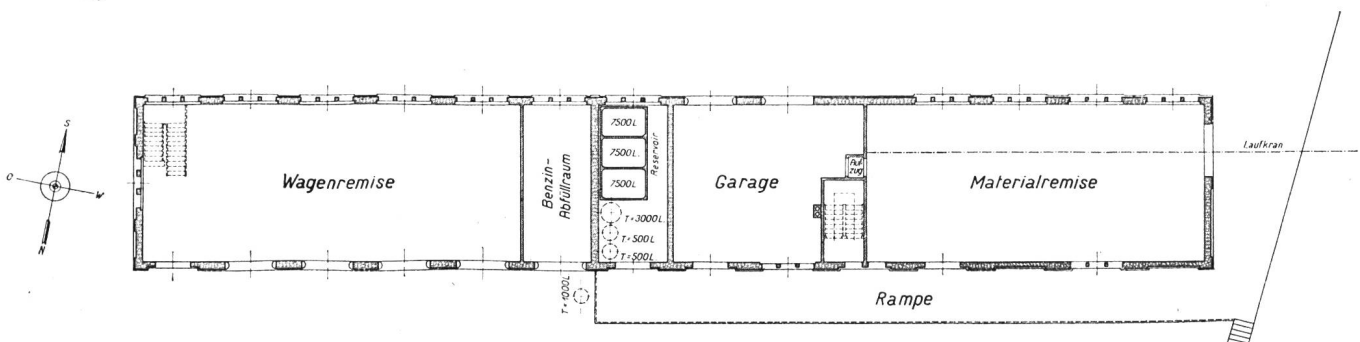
Grundriss der Wagen- und Materialremise.
